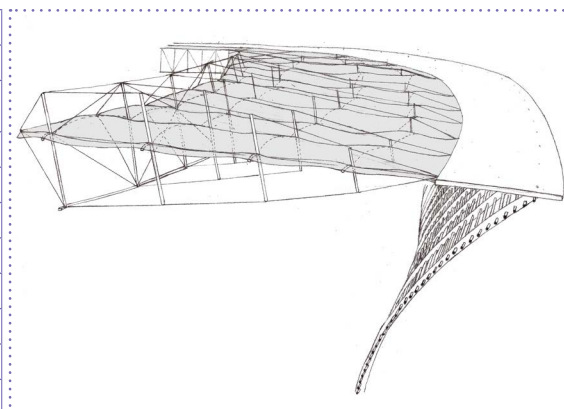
Aspecto exterior de la cubierta del estadio Fonte Nova
